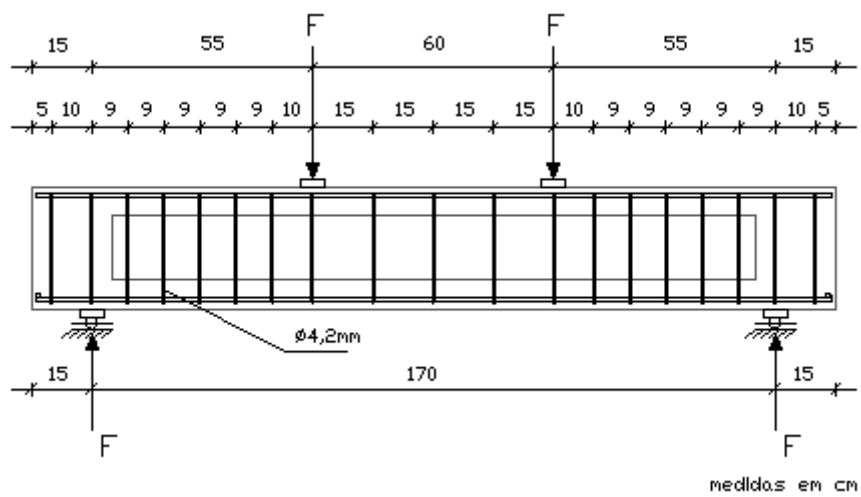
Posição dos estribos, cargas e apoios da viga I-196 (LEITE JÚNIOR, 2000)
